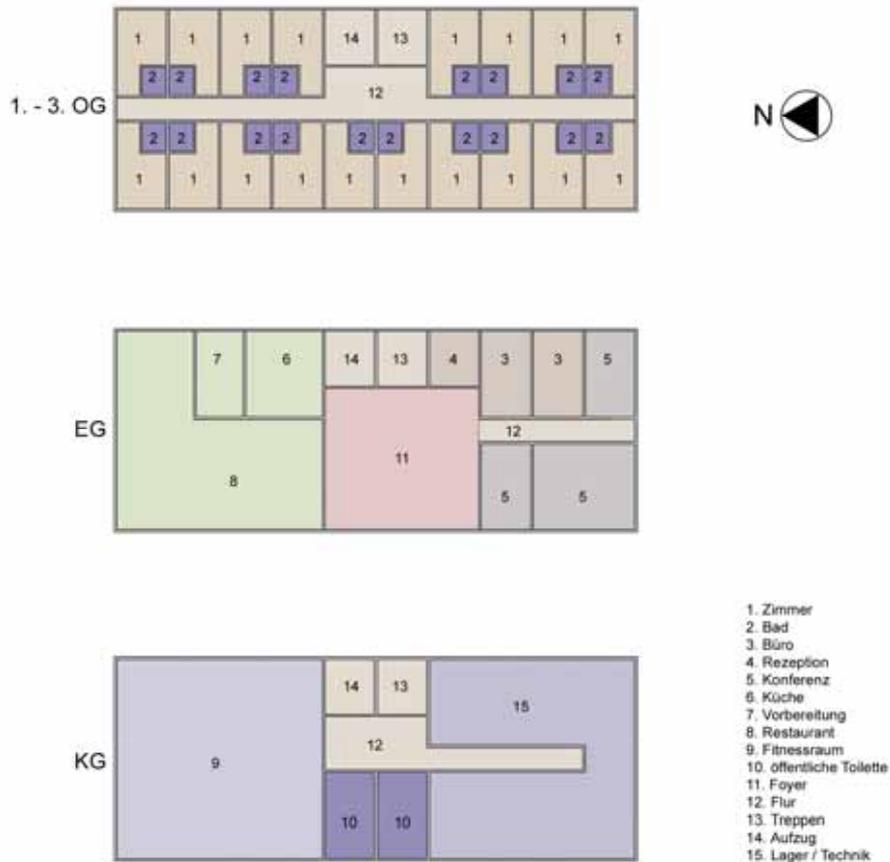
Grundrisse und Zonen des Hotels.
